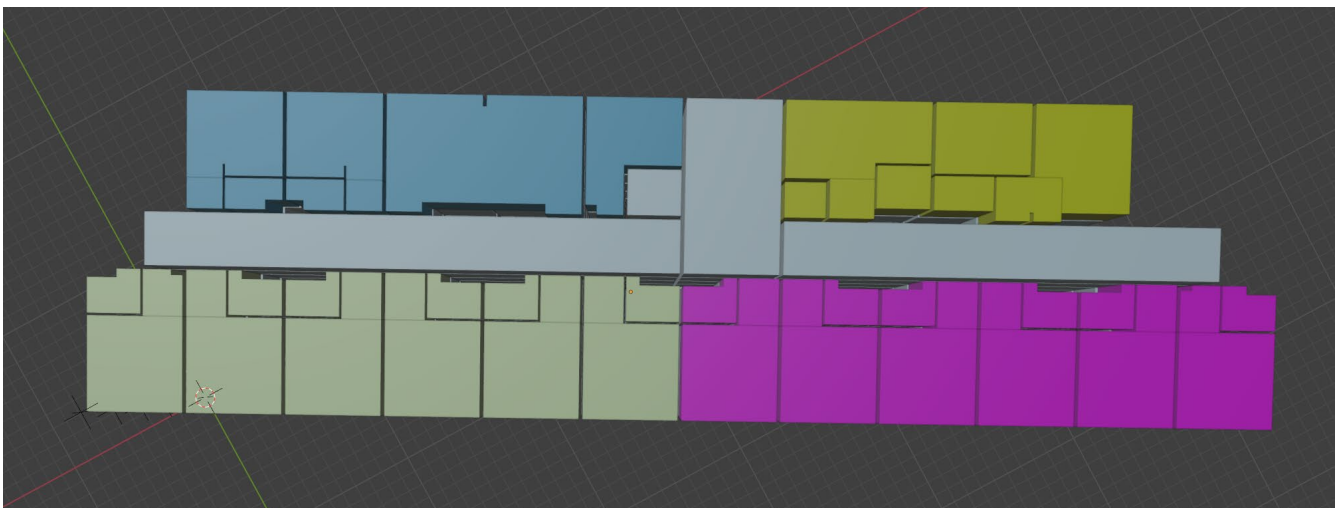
, mit Color by Property eingefärbert Grundriss, eigene Abbildung
